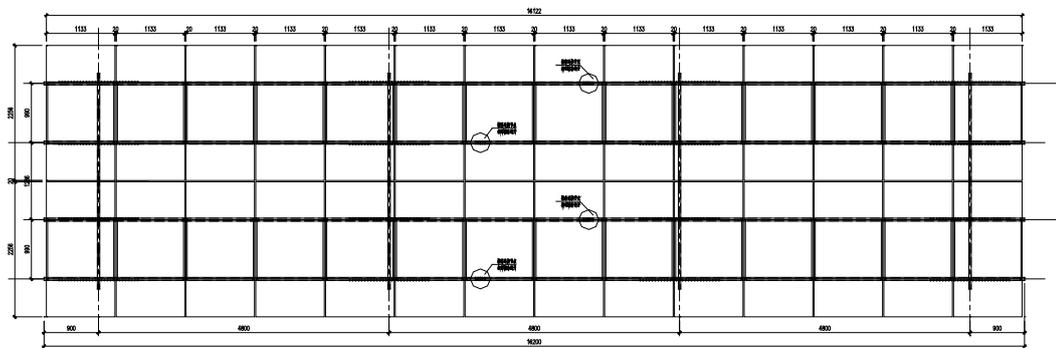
单立柱 2×14 支架组件平面布置图（柱距 4.8m）
